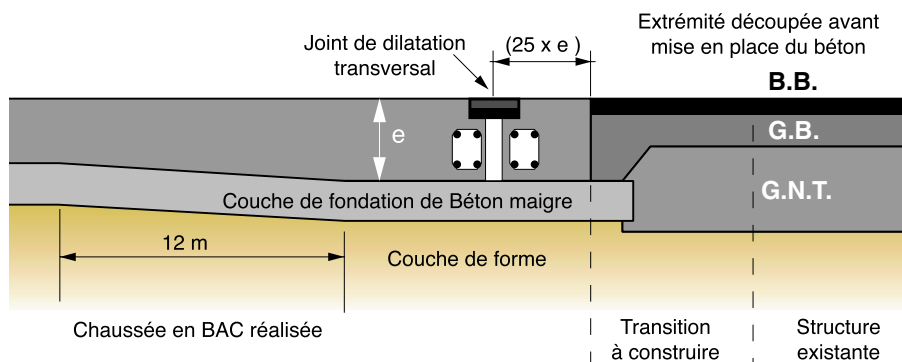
chaussée BAC et chaussée souple à réaliser
